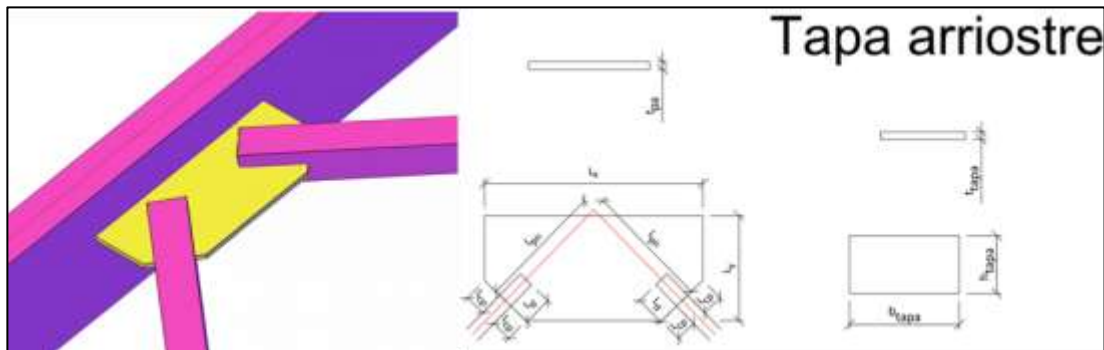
Conexión a corte Doble Techo (Perfiles: tubulares)
